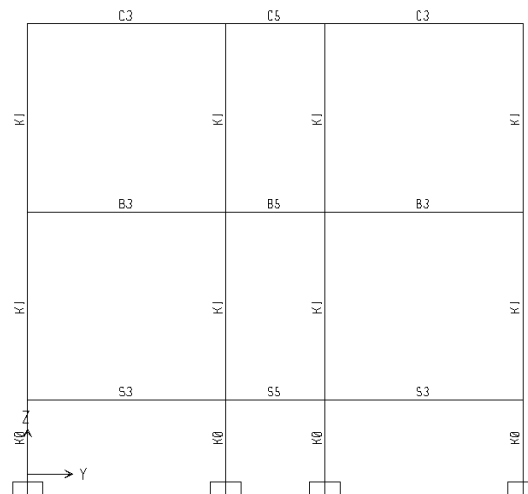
Pemodelan Bangunan 3 Dimensi
